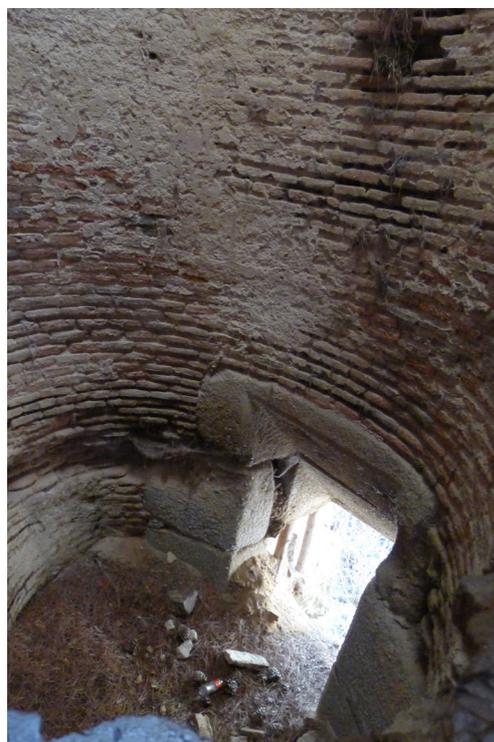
Vista interior de la salida del saetín en el cubo B (foto autora)
